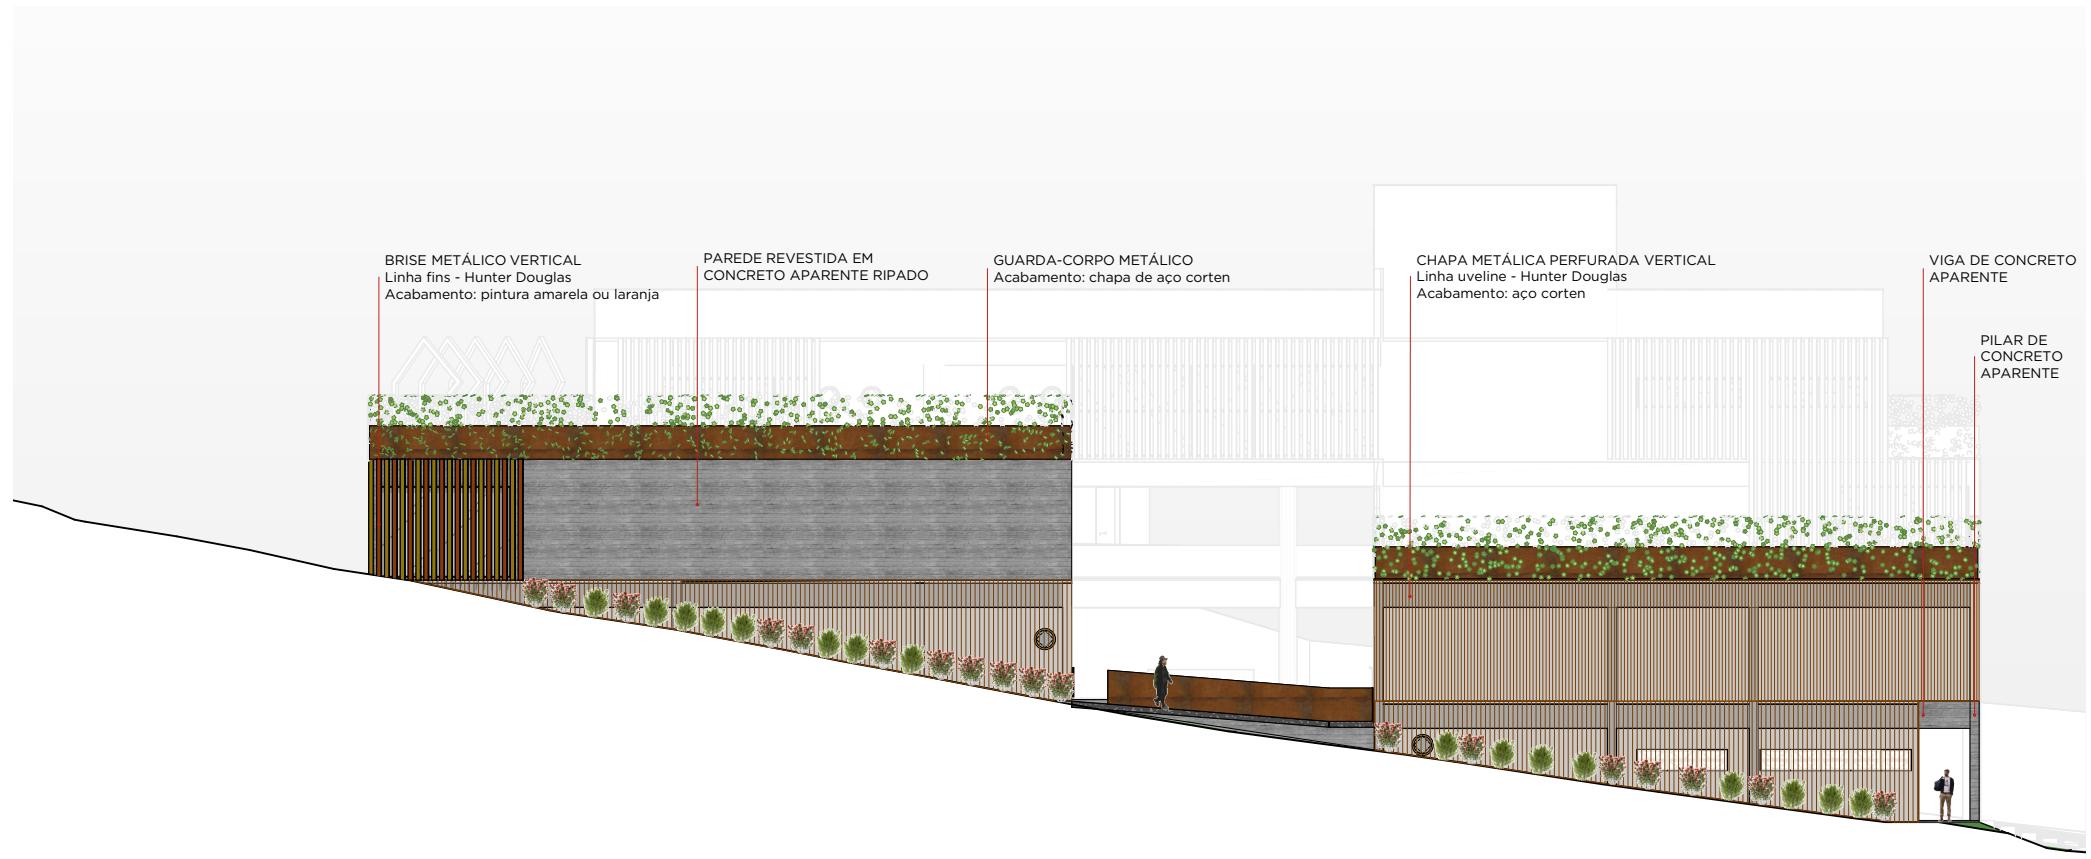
Elevação 02 - Edifício Cultura - Fachada Noroeste. Escala: 1:250.
